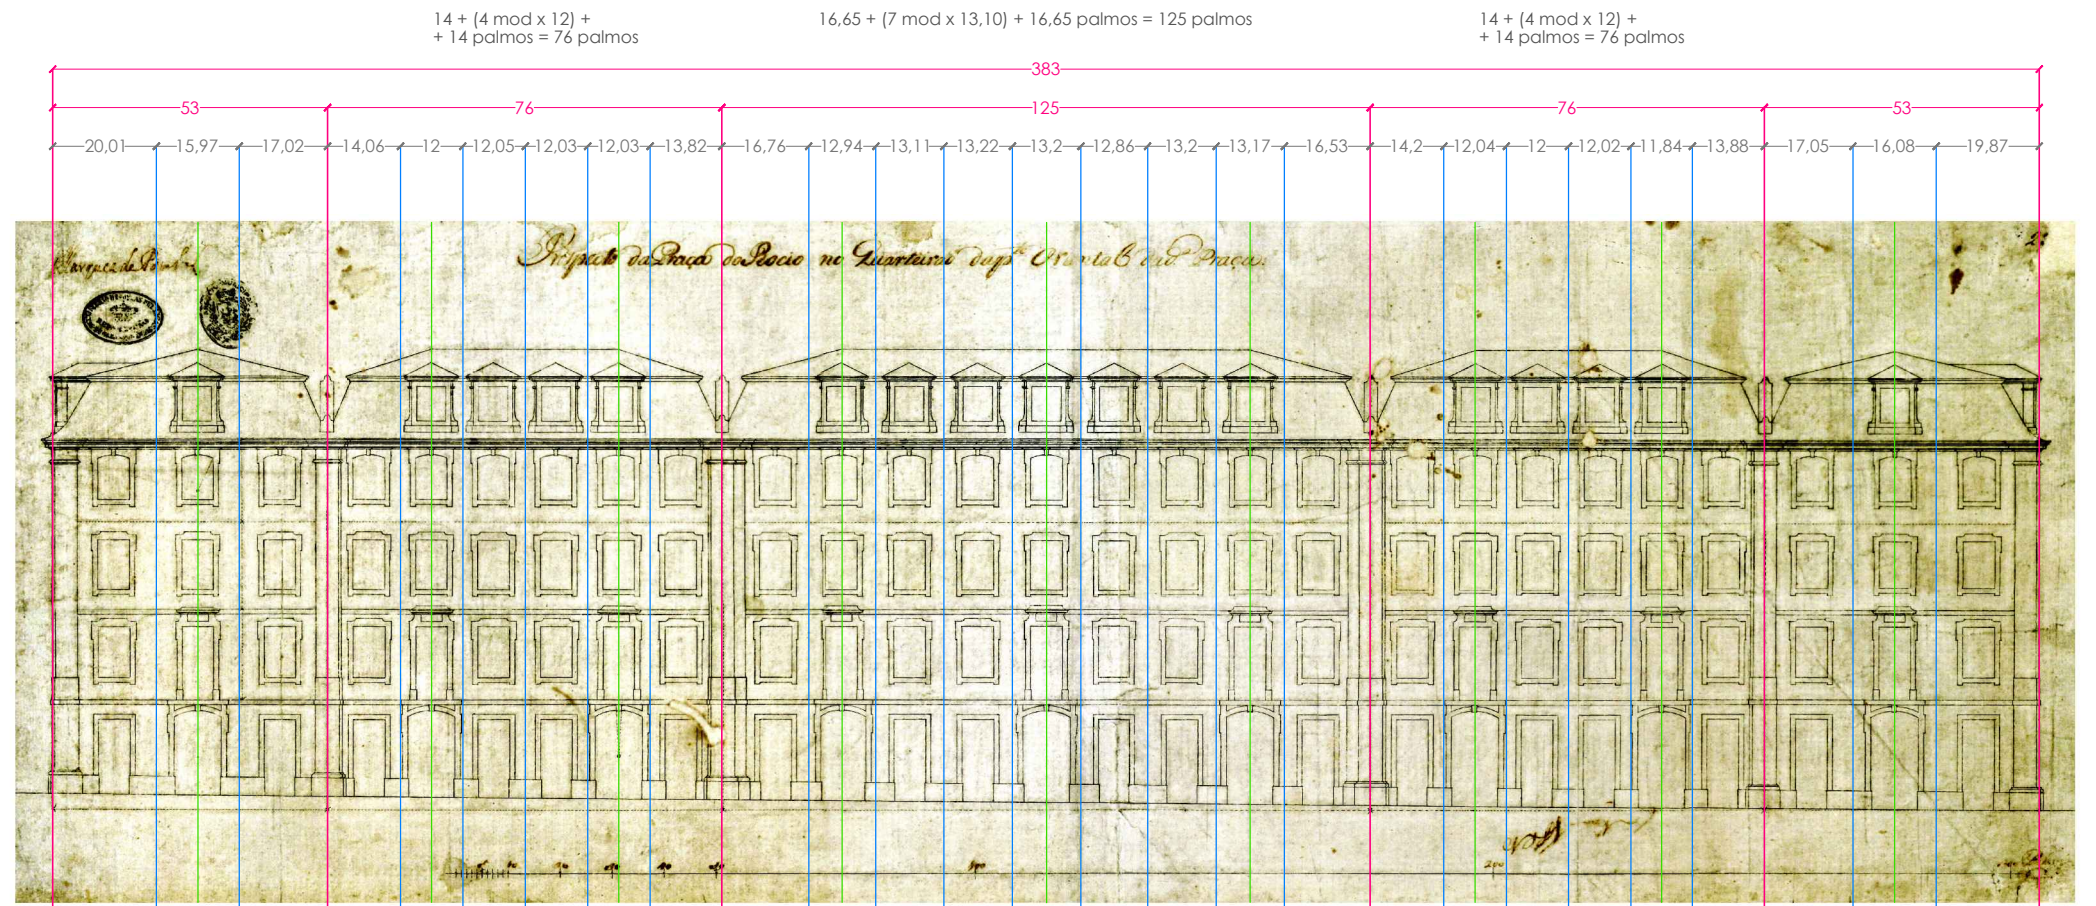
Fachada de la Praça do Rossio, proyecto firmado por el marqués de Pombal.
